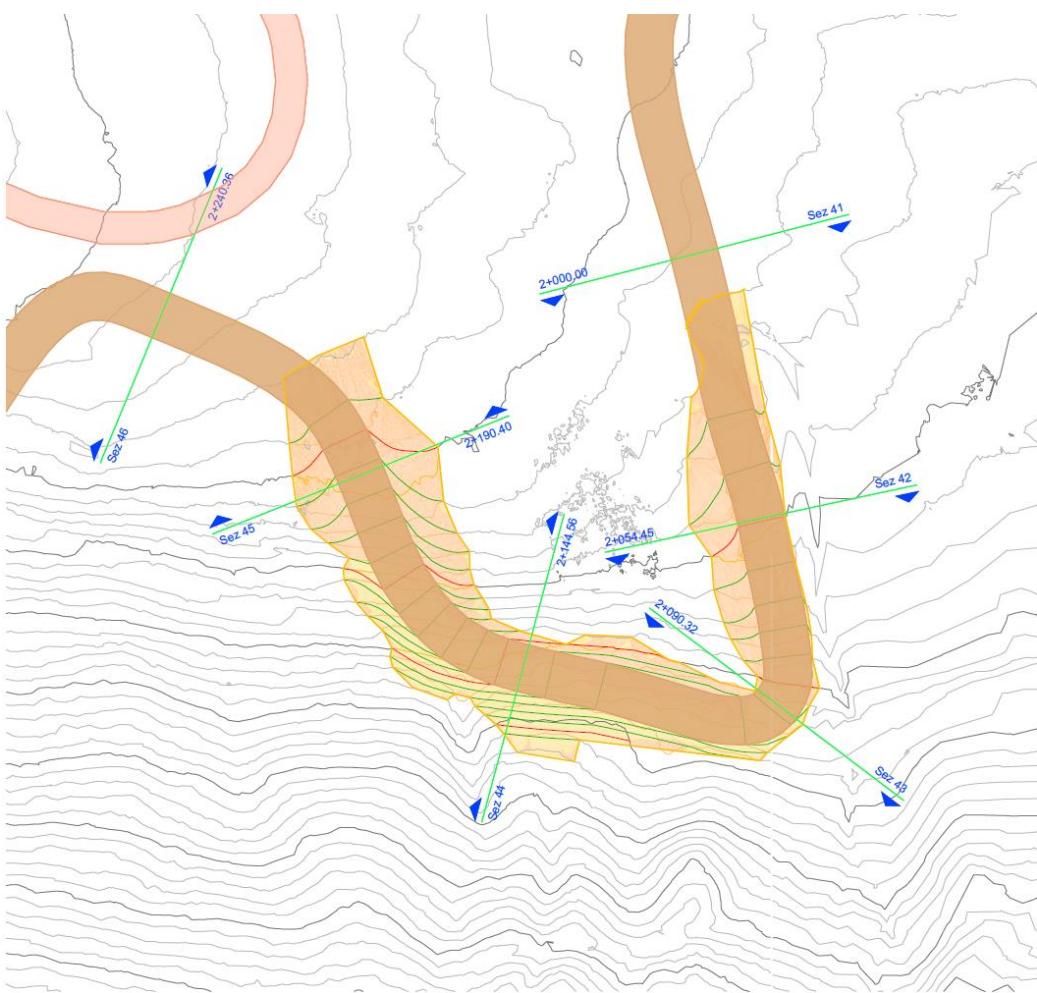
Estratto planimetria sterri e riporti - scala a vista
